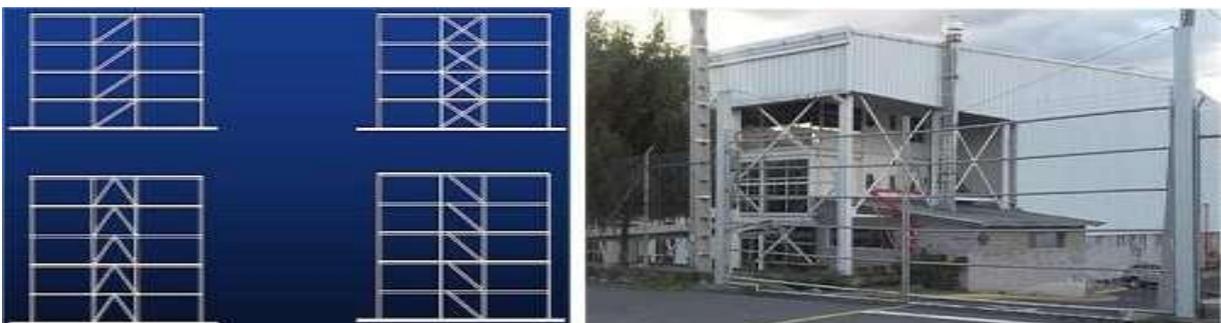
Tipo de sistema estructural: Pórtico de acero laminado co diagonales (S2).
